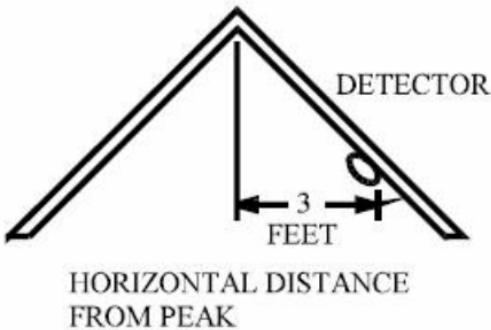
Befestigung eines Rauchmelders auf dem Dachboden.
